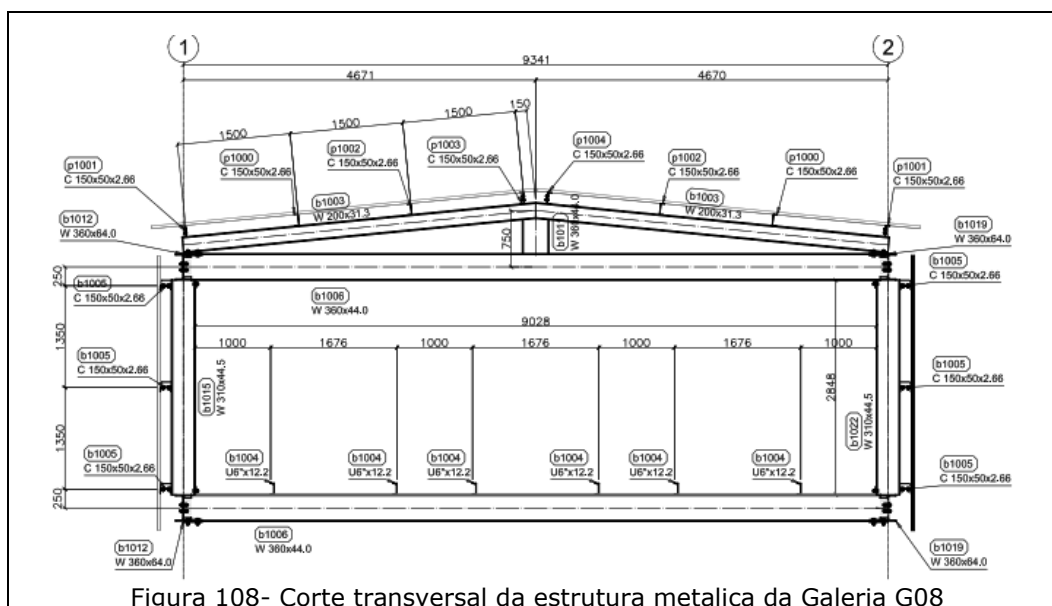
Corte transversal da estrutura metálica da Galeria G08
